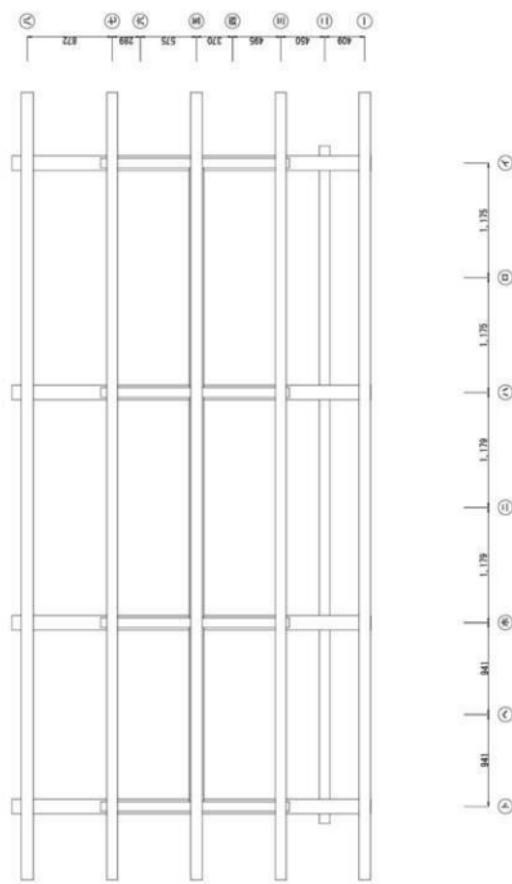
梁屋 竣工 梁伏図 S=1/50
